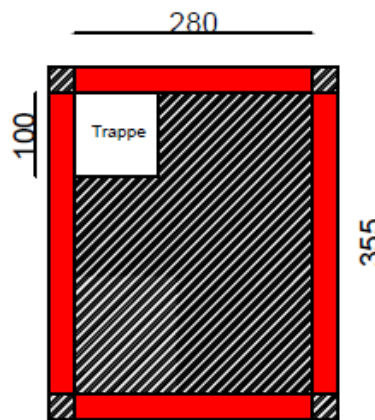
Dalle sur quatre appuis panneau Dp1
